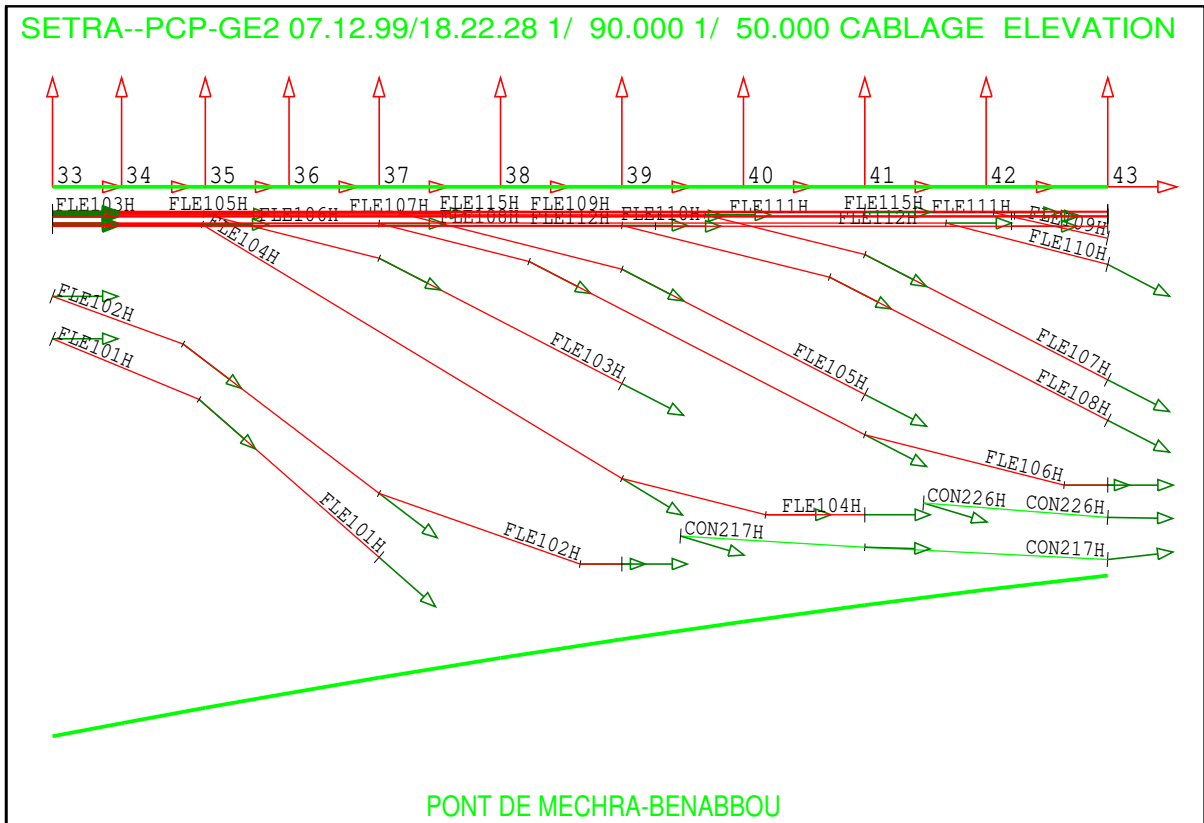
Tronçon de poutre spatiale, coupe longitudinale 1
